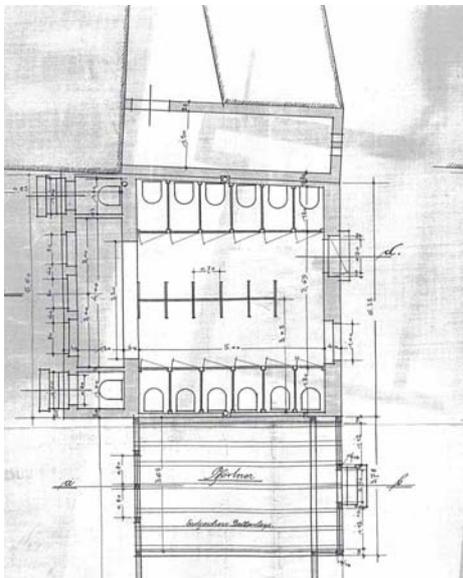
H. Plange, Abortanlage für die Firma C. F. Ern, Grundriss, 1903
